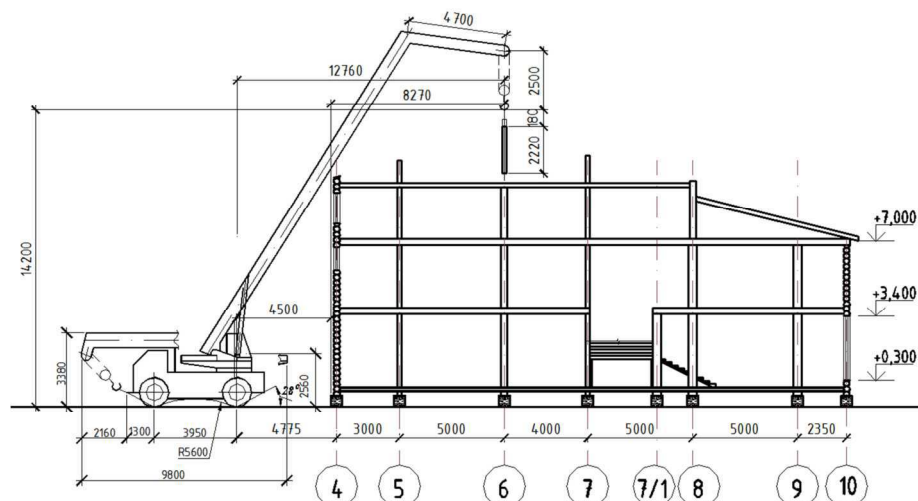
Привязка крана к зданию, при монтаже стойки
